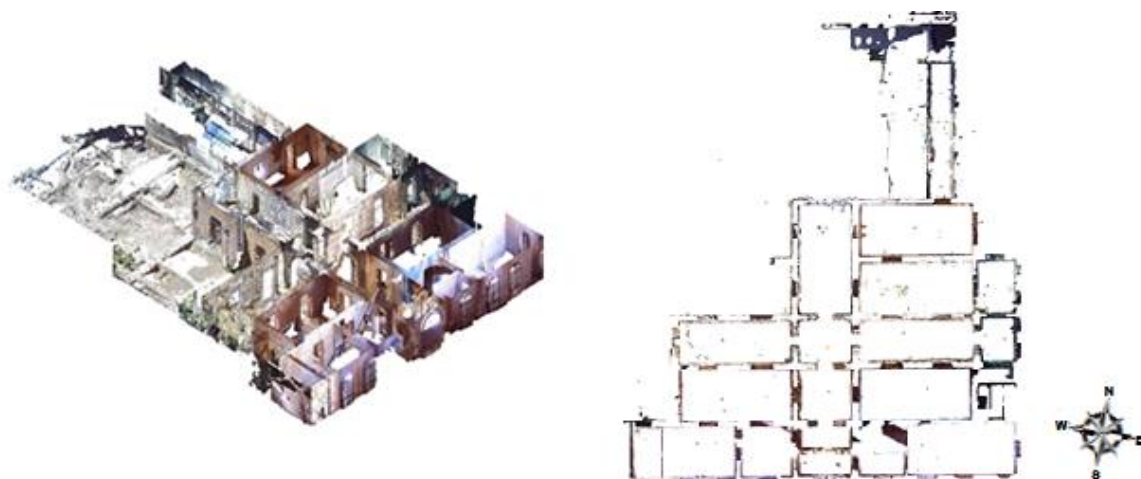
Reconstitución 3D del primer piso del Palacio Pereira y planta del primer piso.
